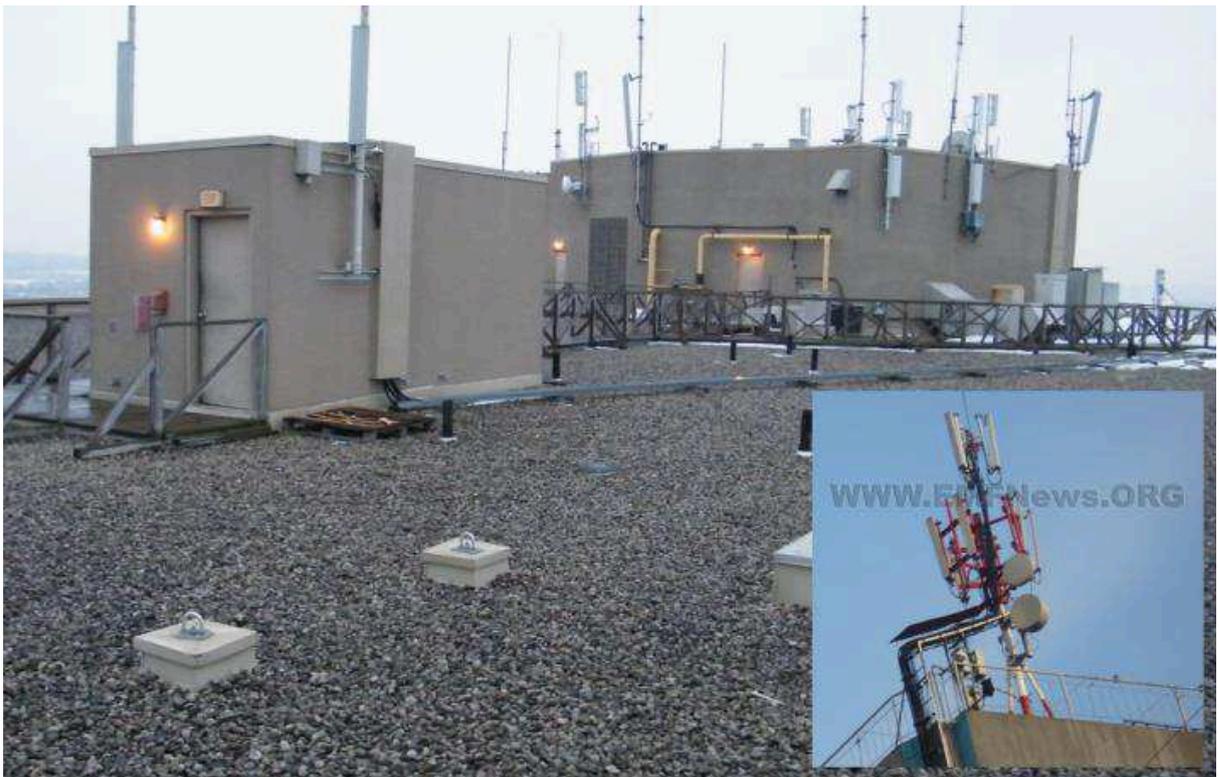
Construção típica de uma ERB em uma laje predial, rooftop. (Fonte:Teleco)
